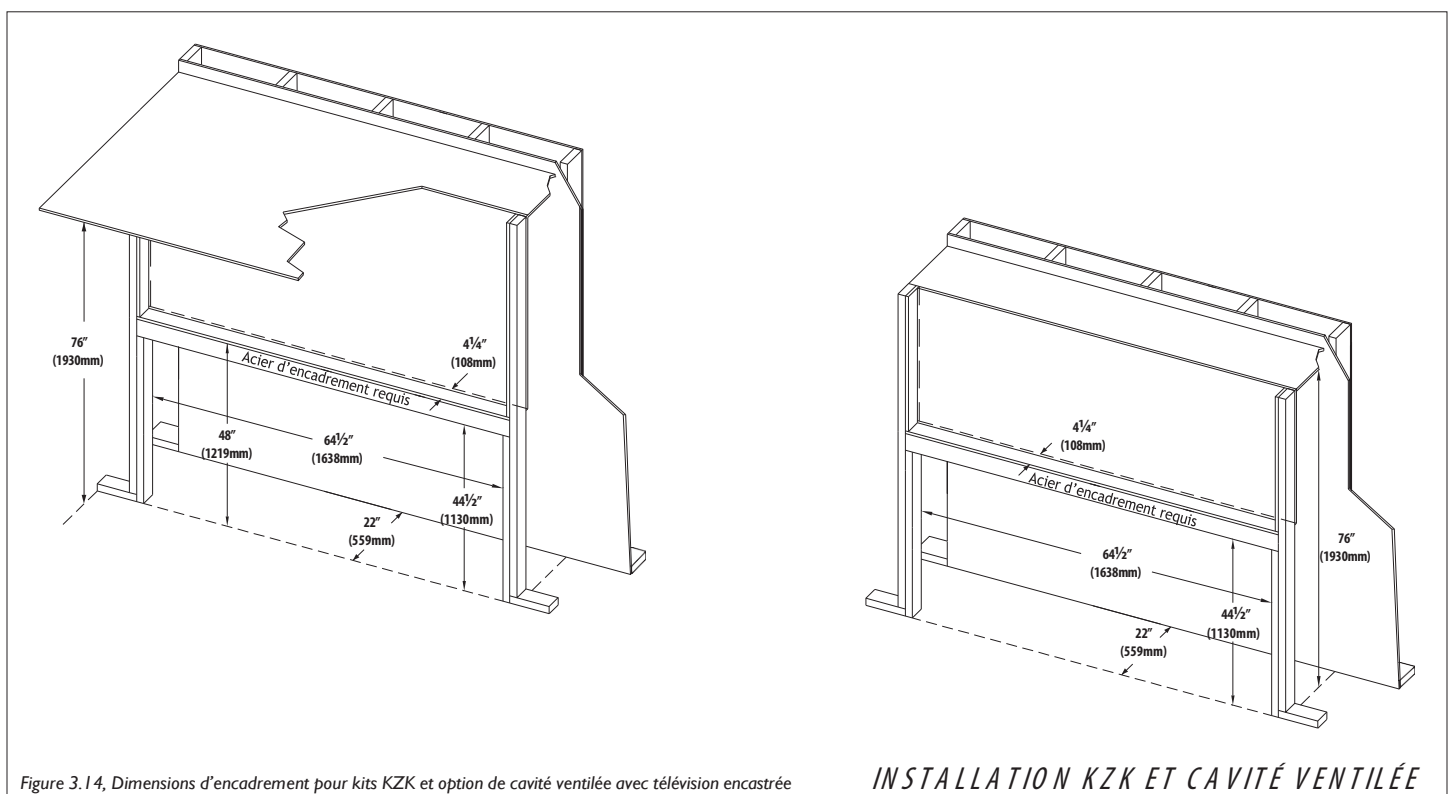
, Dimensions d'encadrement pour kits KZK et option de cavité ventilée avec télévision encastrée
